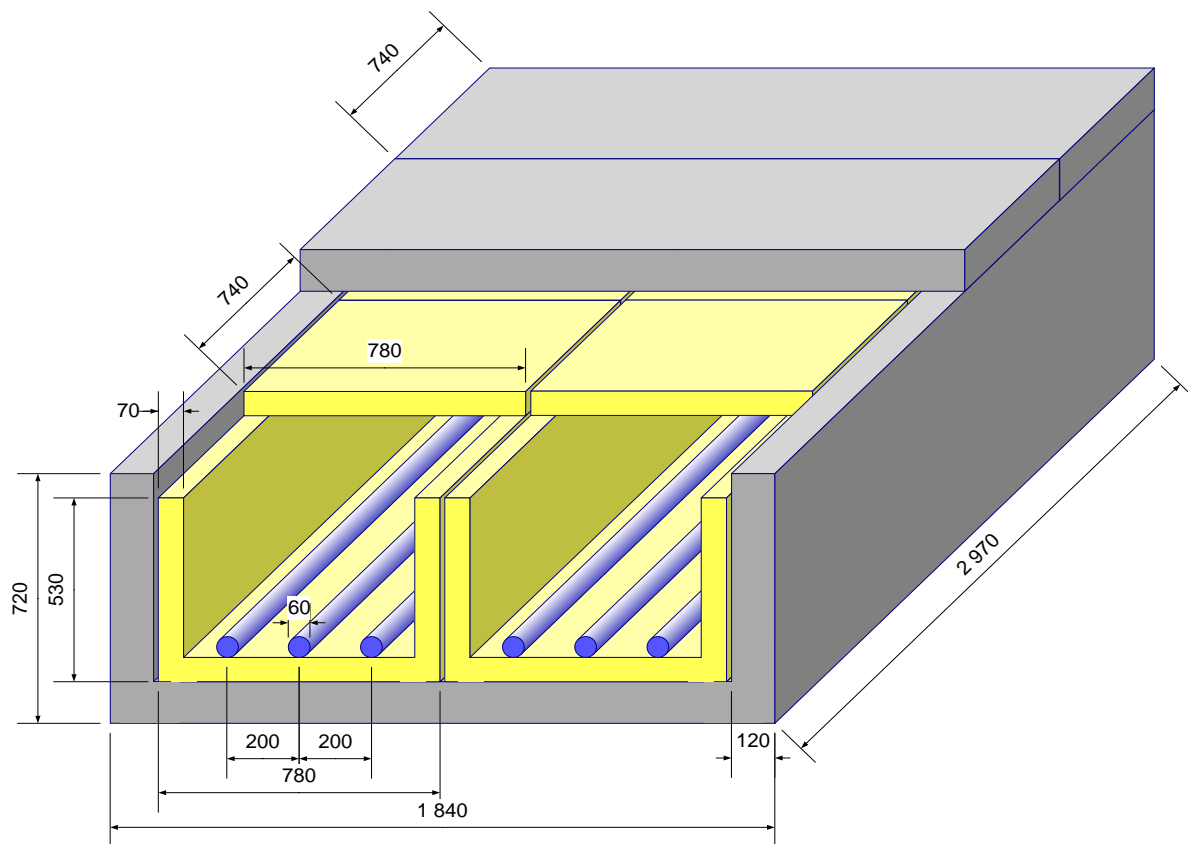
Прокладка двухцепной кабельной линии в железобетонных лотках
